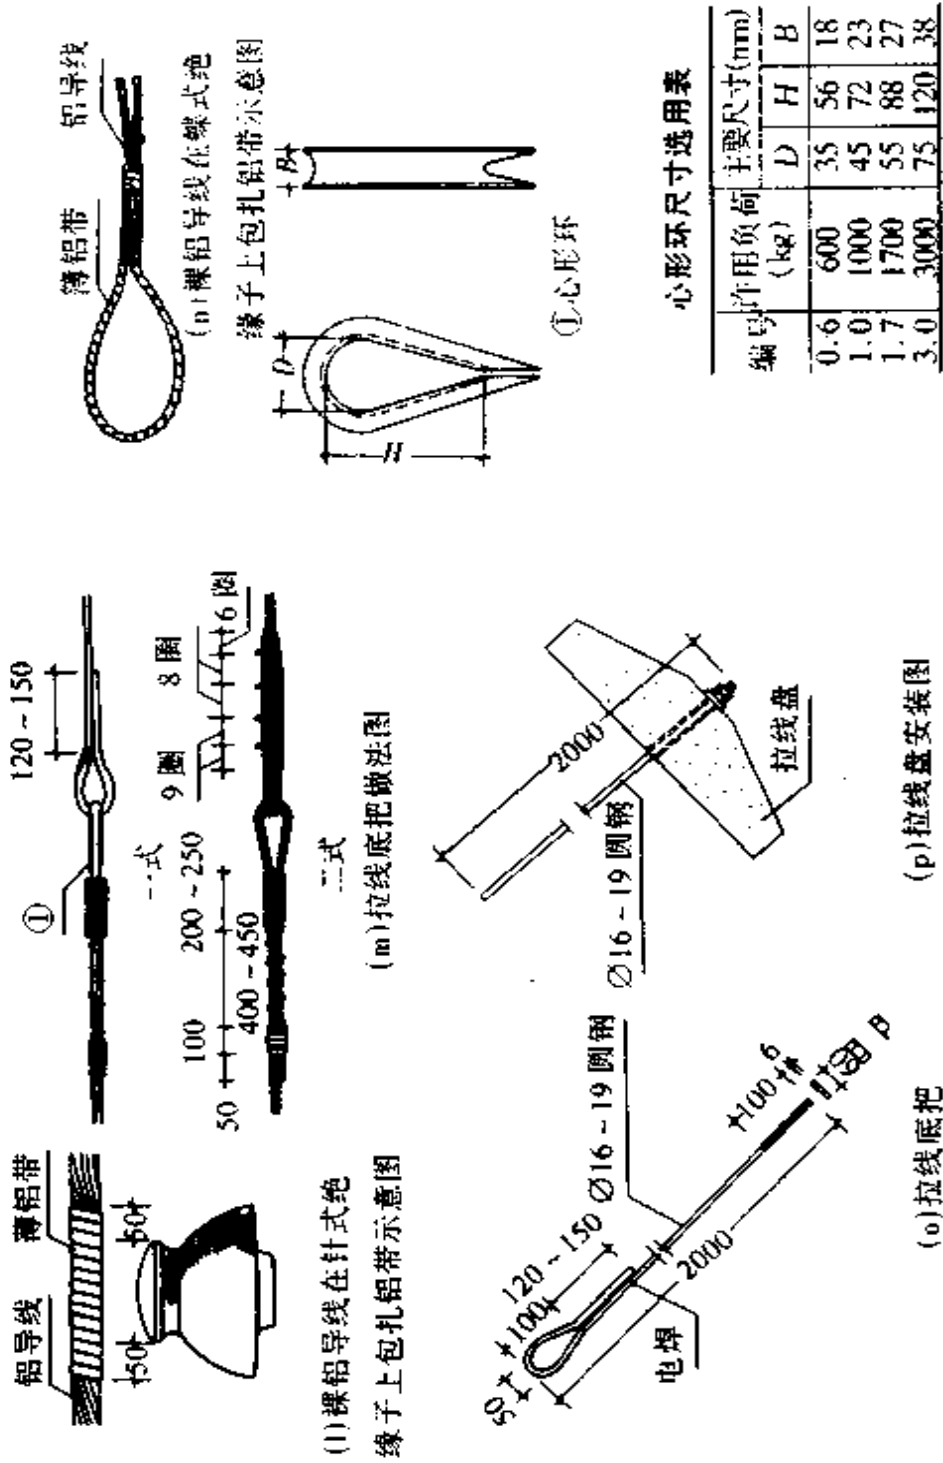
钢筋混凝土电杆各种附件安装图(三)
